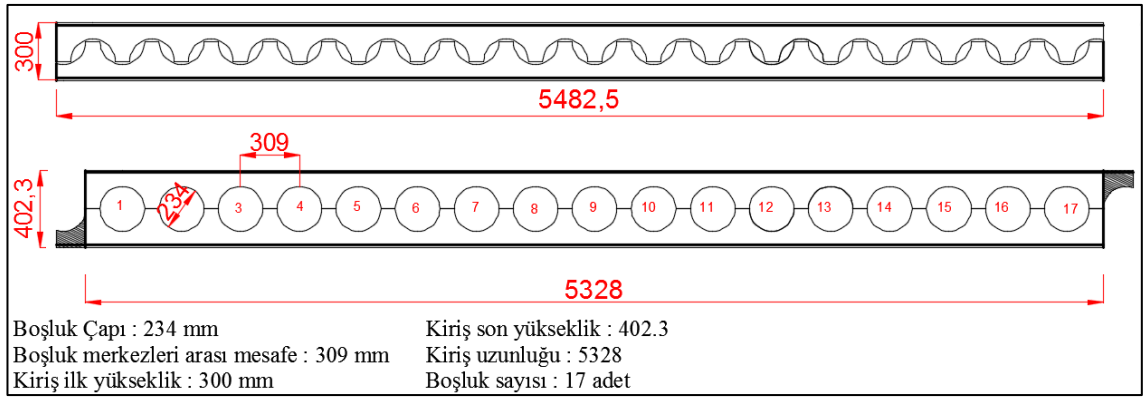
IPE 240 petek boşluklu çelik kiriş (IPE_PB_240) detayı
